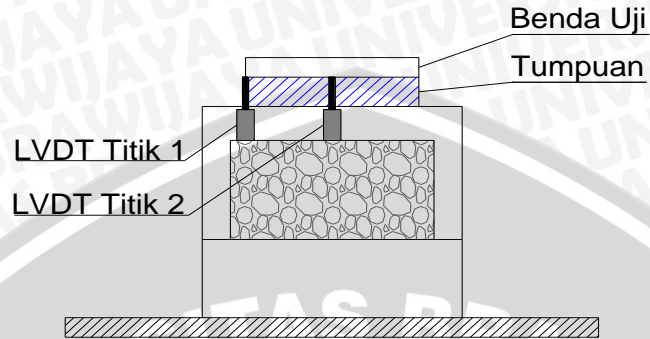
Detail Potongan Melintang Benda Uji SSB
